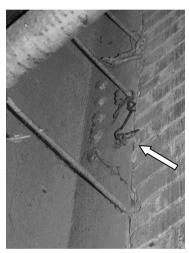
Узел жесткого болтового крепления несущих металлических балок перекрытия двухэтажной части корпусного цеха к металлической колонне двухпролетного цеха
